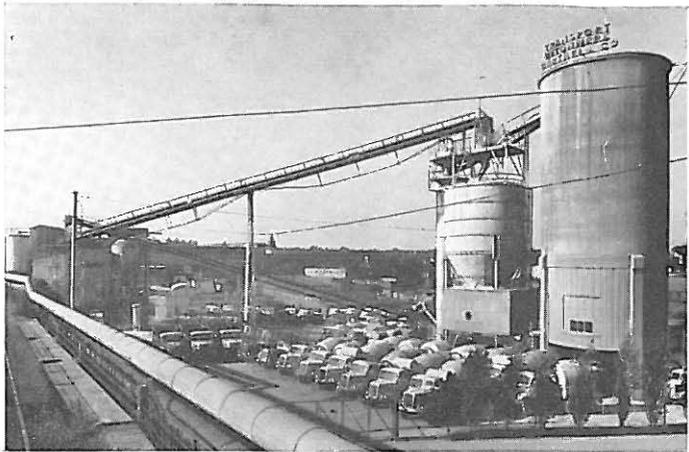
Transportbetonwerk in Essen mit zweitem „Dosierturm“ aus Stahlbeton
